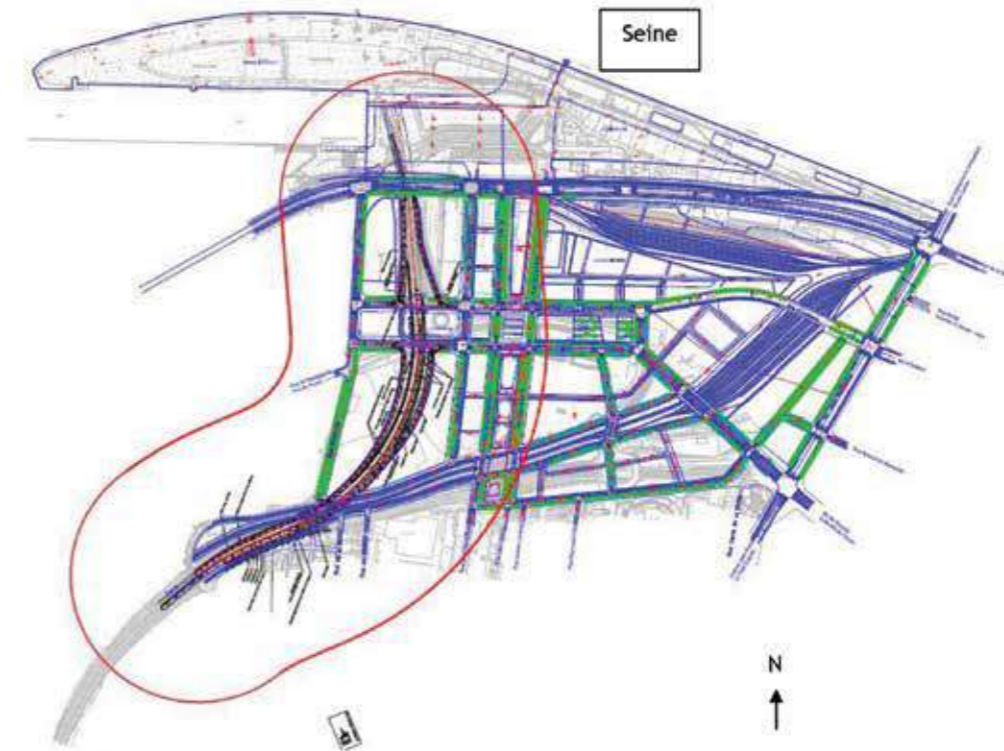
Plan du projet (Source: DREAL HN, 2013)
